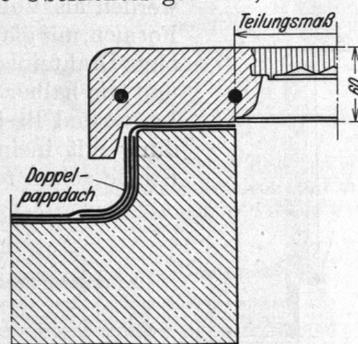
Anschluß eines Doppelpapdaches an die Betonzarge eines aufgelegten Glasbeton-Dachoberlichtes.
